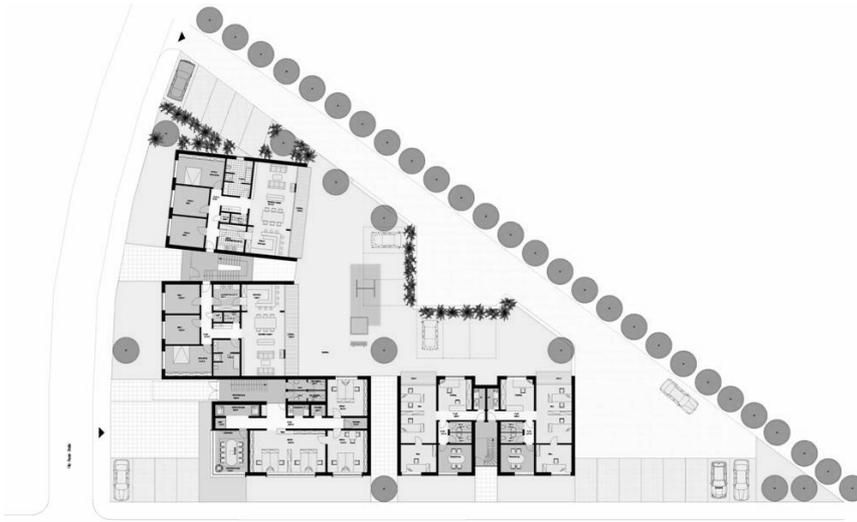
Lageplan Bauvorhaben / Entwurf
